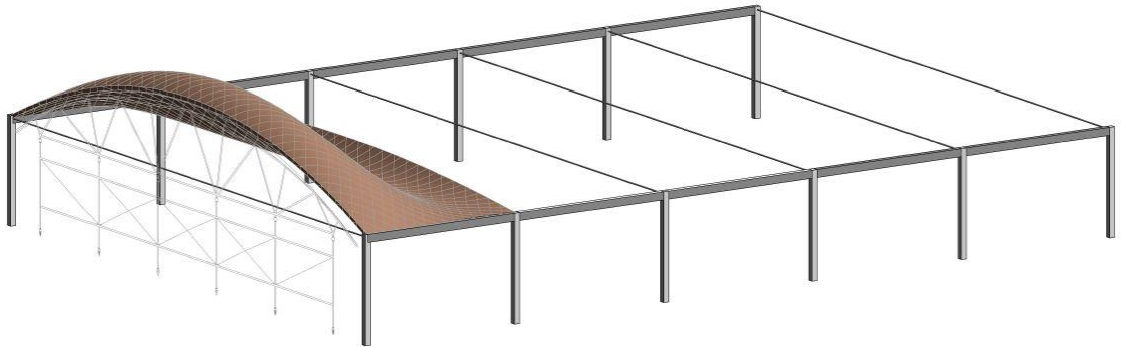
Proceso constructivo Fase 6 Fuente: Elaboración propia
